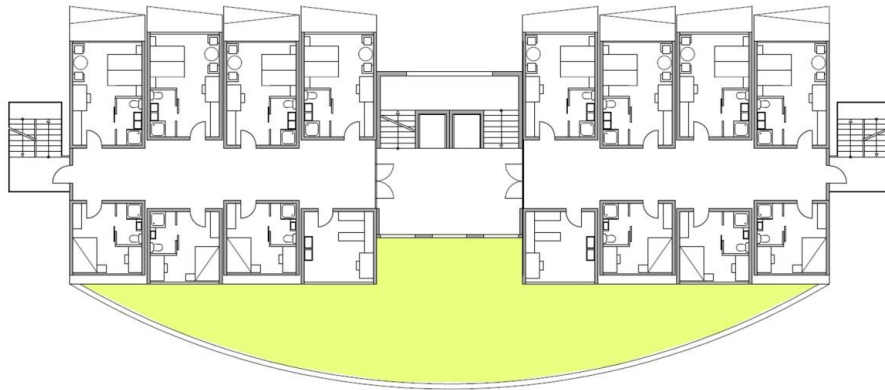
Grundriss 2.OG Eigenentwurf Hotelgebäude
